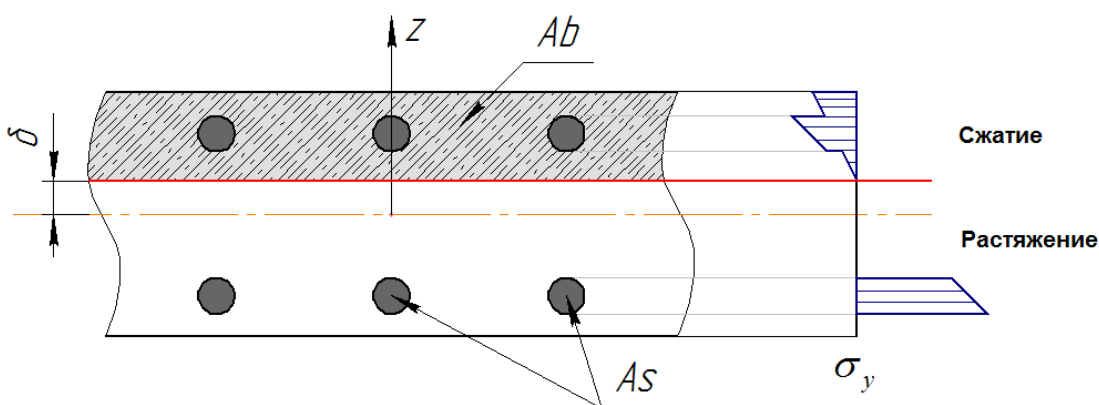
Поперечное сечение ограждения (A_s – армирующий элемент, A_b – бетон).
